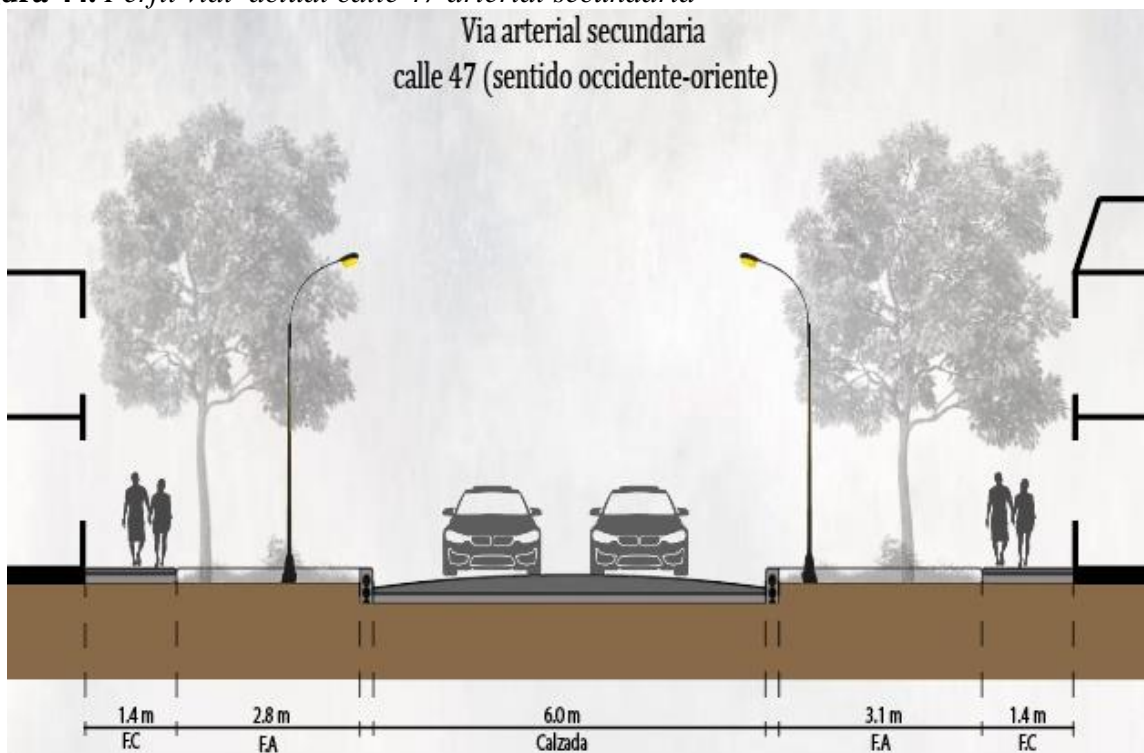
Perfil vial propuesto para la calle 47 arterial secundaria
